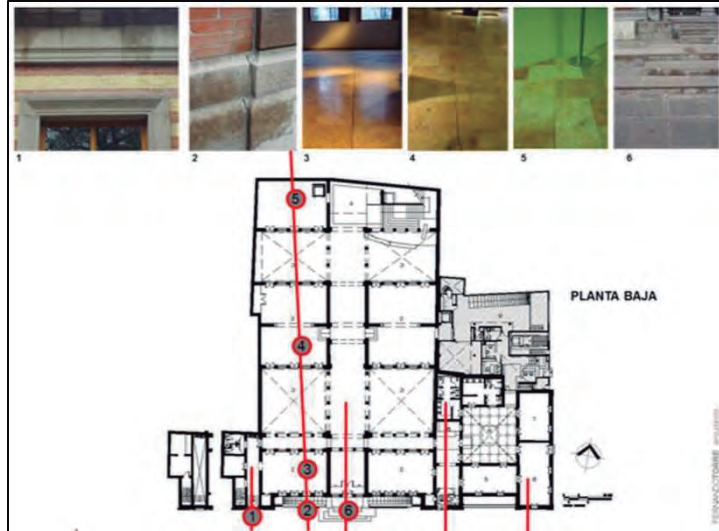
Localización de grietas en la planta baja del Museo Federico Silva.
